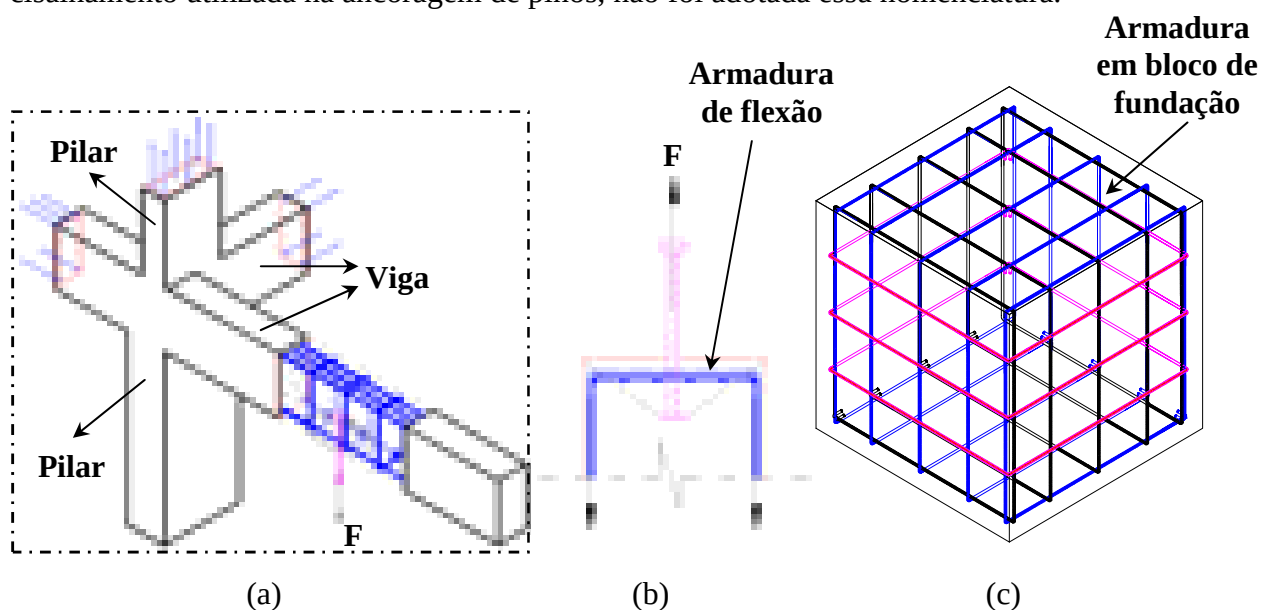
Exemplos de ferragens que atuam como armadura de flexão do pino de ancoragem: (a) Em uma viga; (b) Detalhe de uma seção da viga; (c) Em um bloco de fundação.
